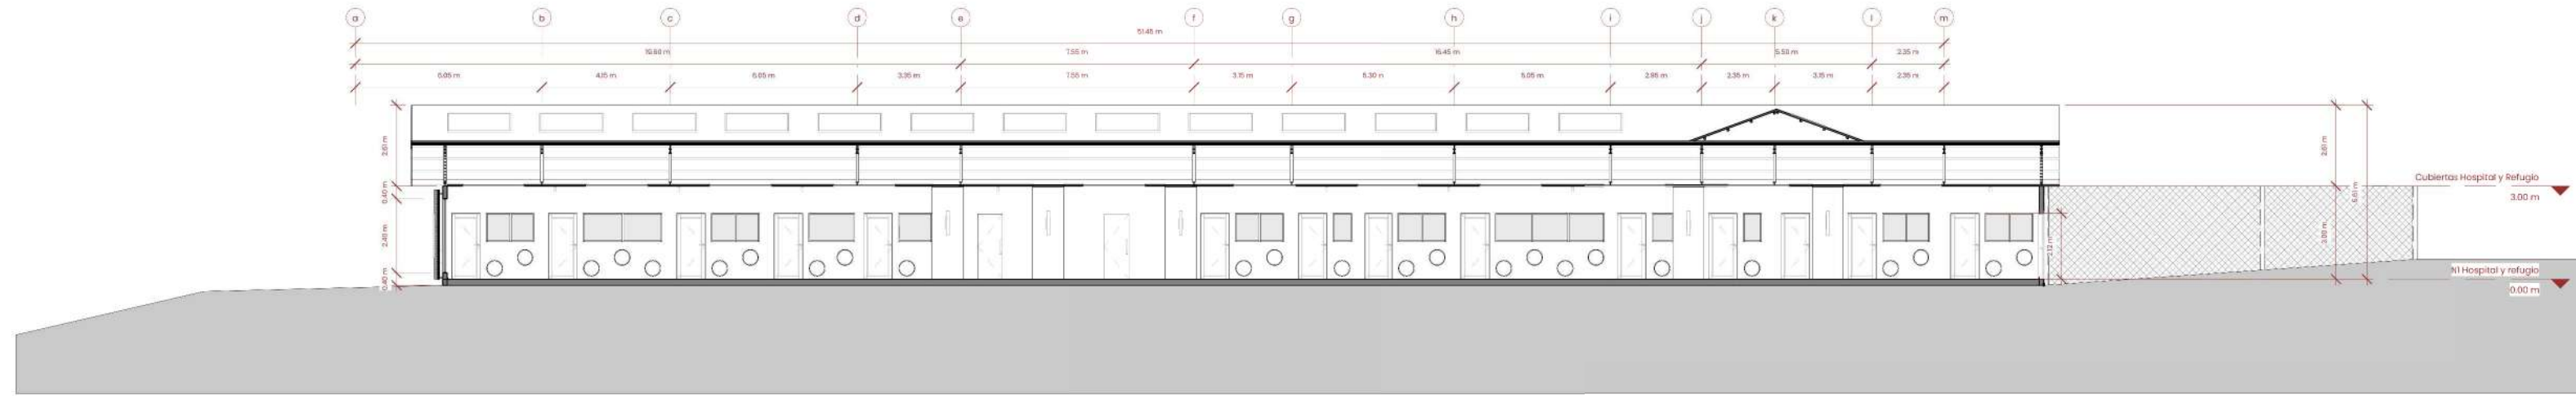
Corte longitudinal refugio. Fuente: Elaboración propia
